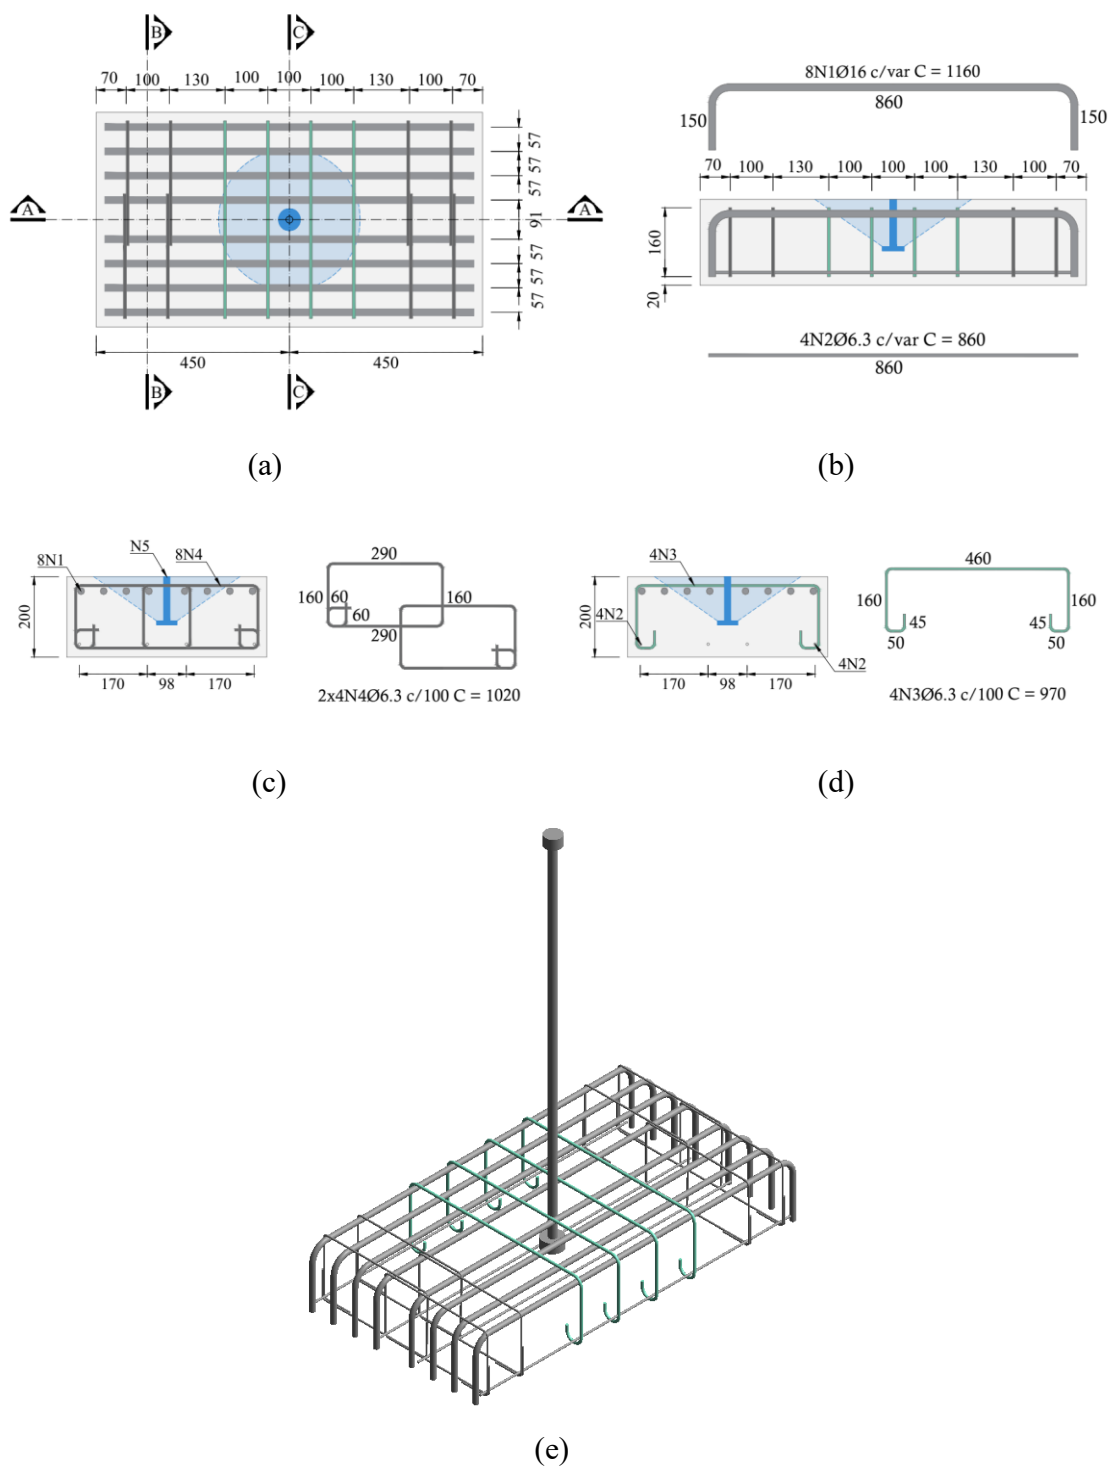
Projeto executivo da série 1: (a) Planta Baixa; (b) Corte AA; (c) Corte BB; (d) Corte CC.
